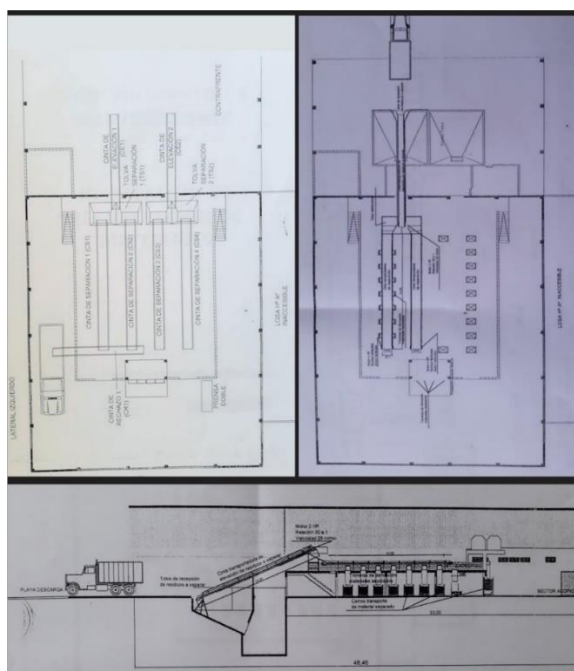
Planta Modelo de Proyecto ECO-DES.
